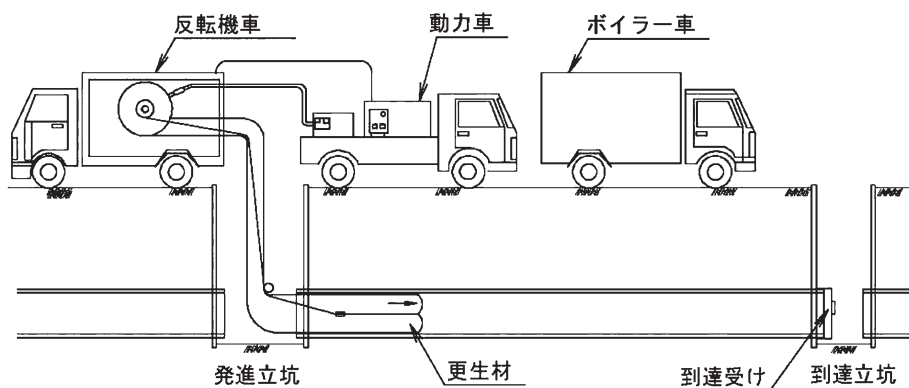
補修・補強工事の施工例（反転工法（熱硬化タイプ）の施工概要図）
